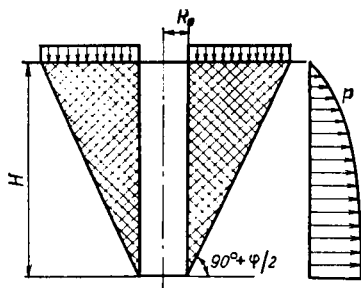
Схема к расчету нагрузки на крепь вертикальной выработки методом проф. В. Г. Березанцева
